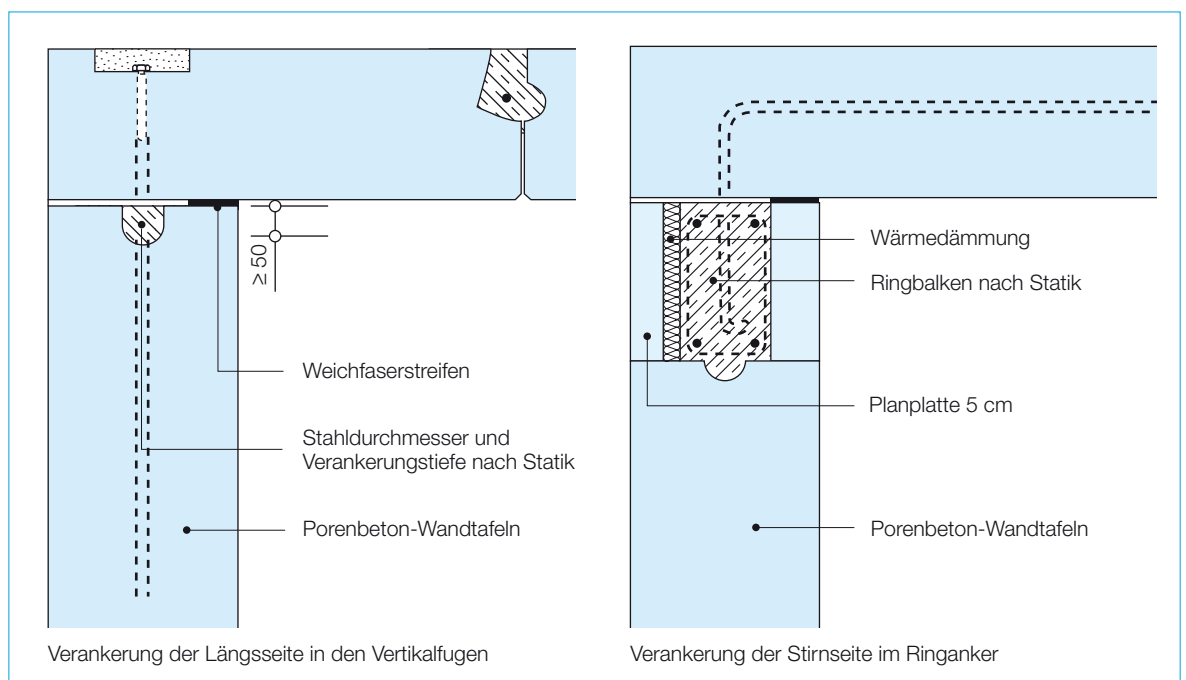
Endauflagerung und Verankerung von Porenbeton-Dachplatten auf Porenbeton-Wandtafeln
